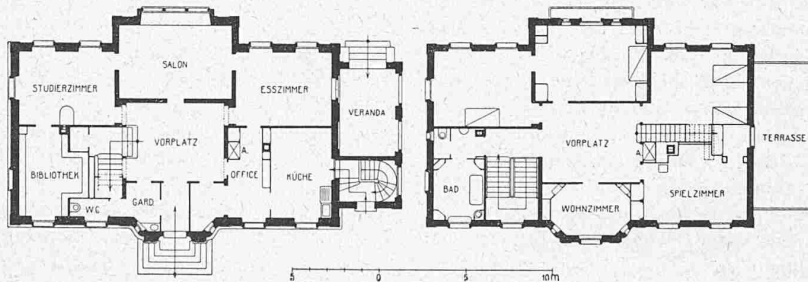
und 2. Grundrisse 1:400. — Abb. 3 (unten). Lageplan 1:800.
